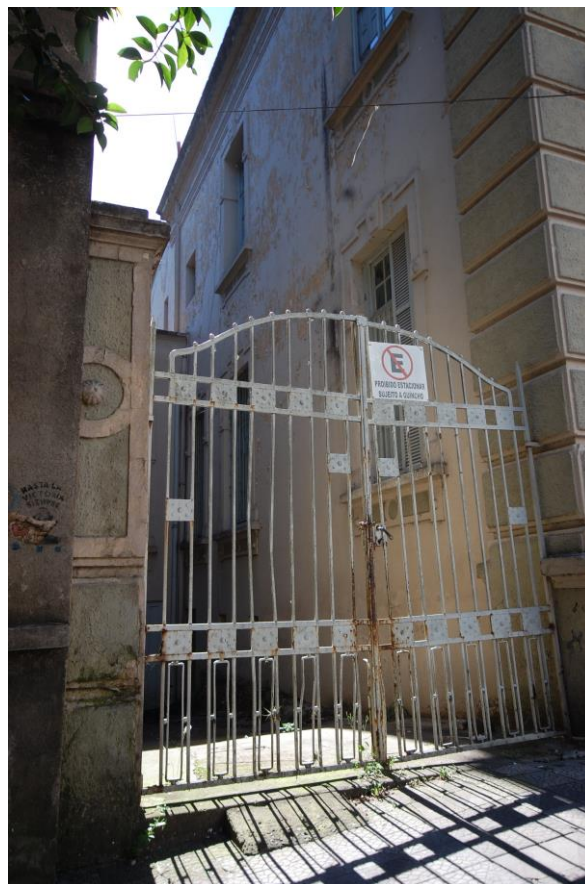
Fachada norte da edificação, visto de frente na edificação.
